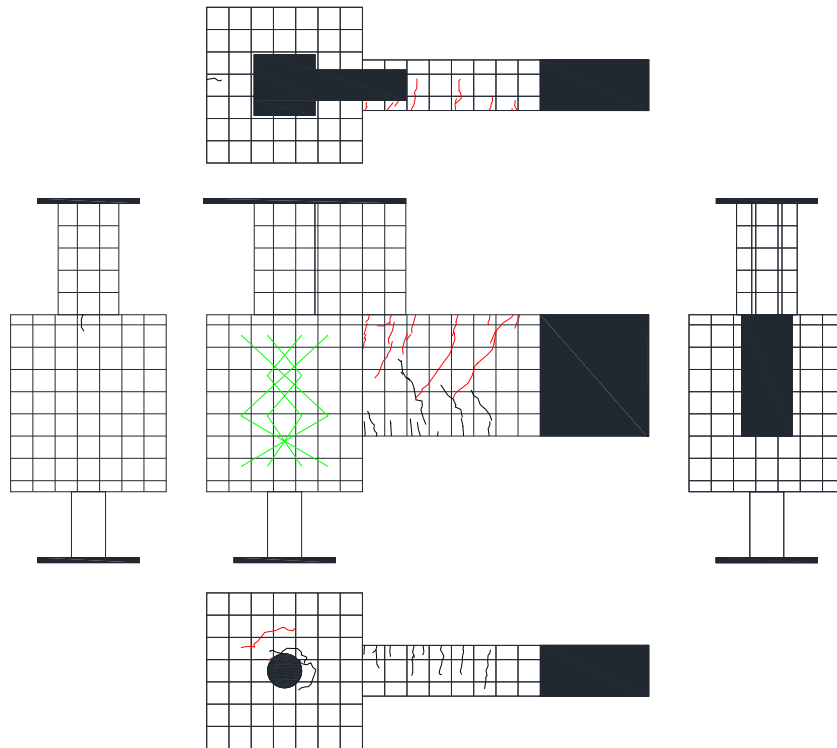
試験体 DR-3 ひび割れ状況 (4Cycle)
